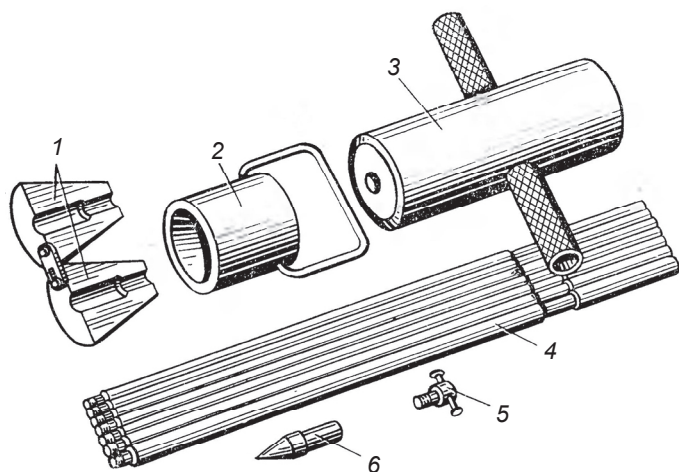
Заземлитель и приспособление для его забивки [4, кн. 3, с. 105]:
